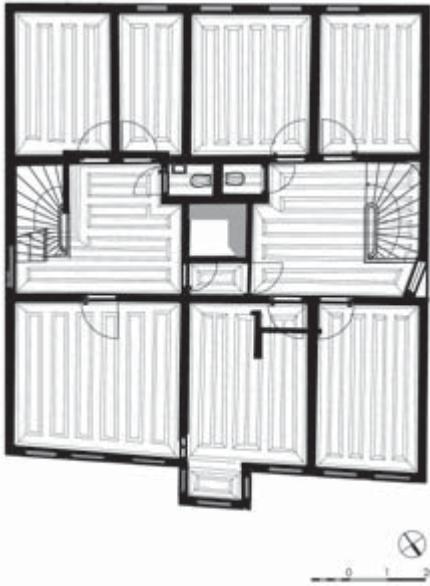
Obergeschossgrundriss des Doppelhauses Hüseyin Rahmi Bey Sokağı 4–6 auf Heybeli Ada mit Deckenspiegel, M. 1:200
